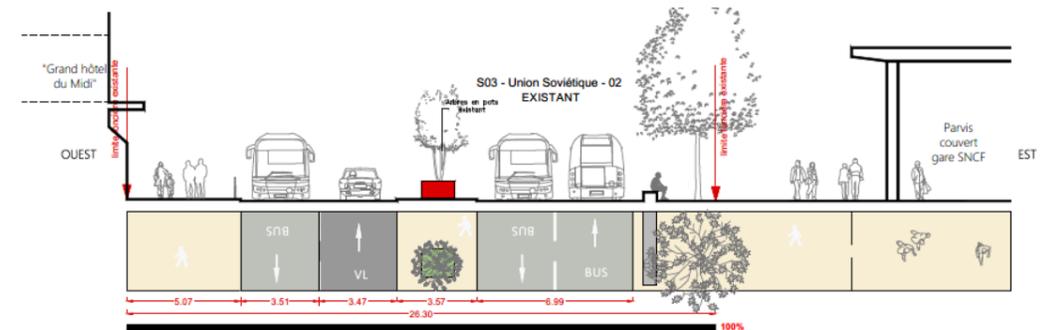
Profil existant sur le boulevard de l'Union Soviétique au droit de la gare
